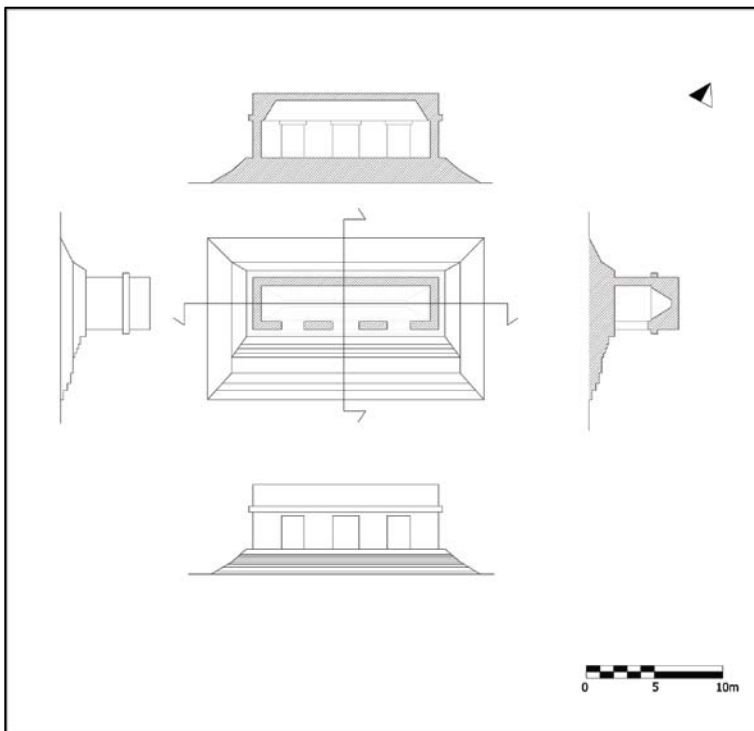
Propuesta de reconstrucción con tres accesos. (Elaboración A. Campiani)
